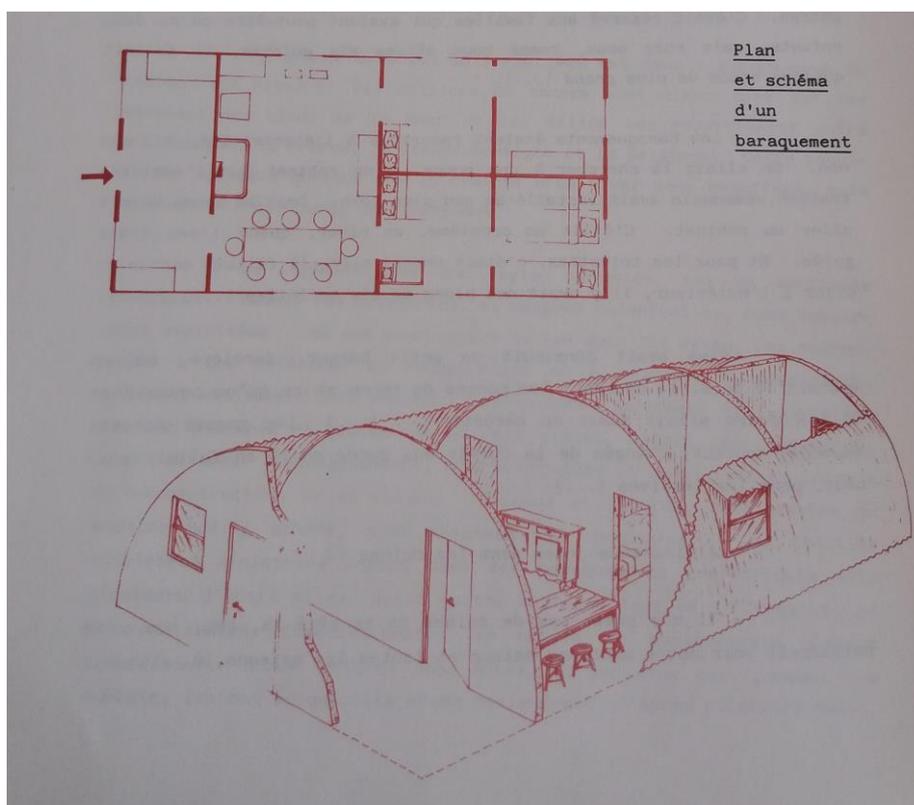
Plan et coupe d'un abri tunnel, Villers-la-Bonne-Eau, s.d. © Coll. Fabrice Gérardy
